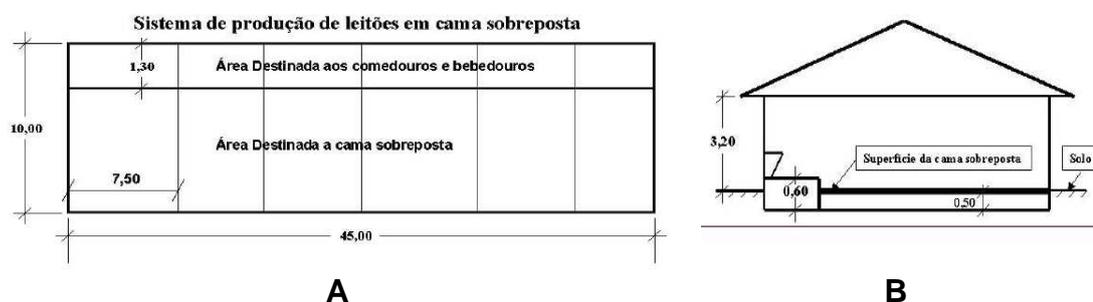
Modelo de creche utilizado em sistema de produção de leitões em cama sobreposta: A. croqui de planta baixa; B. croqui de corte transversal (OLIVEIRA et al., 2002).
